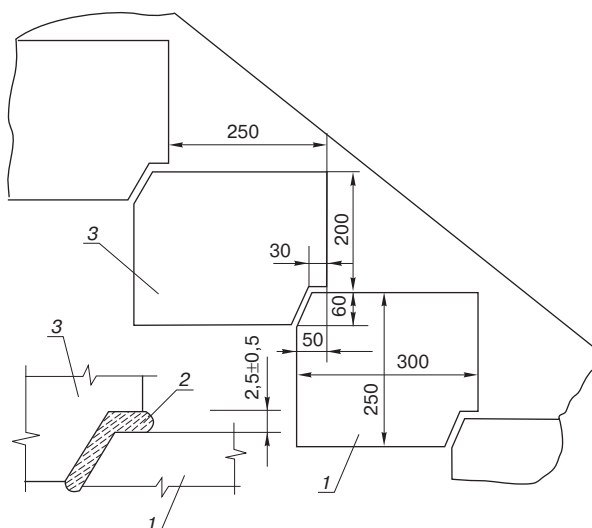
Конструктивное решение герметизации лестничных ступеней: 1 – опорный камень; 2 – герметик-эластомер; 3 – монтируемый блок (камень или бетон)
